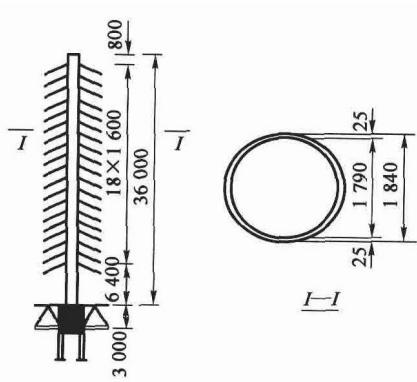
紫洞大桥塔柱布置(尺寸单位:mm)
